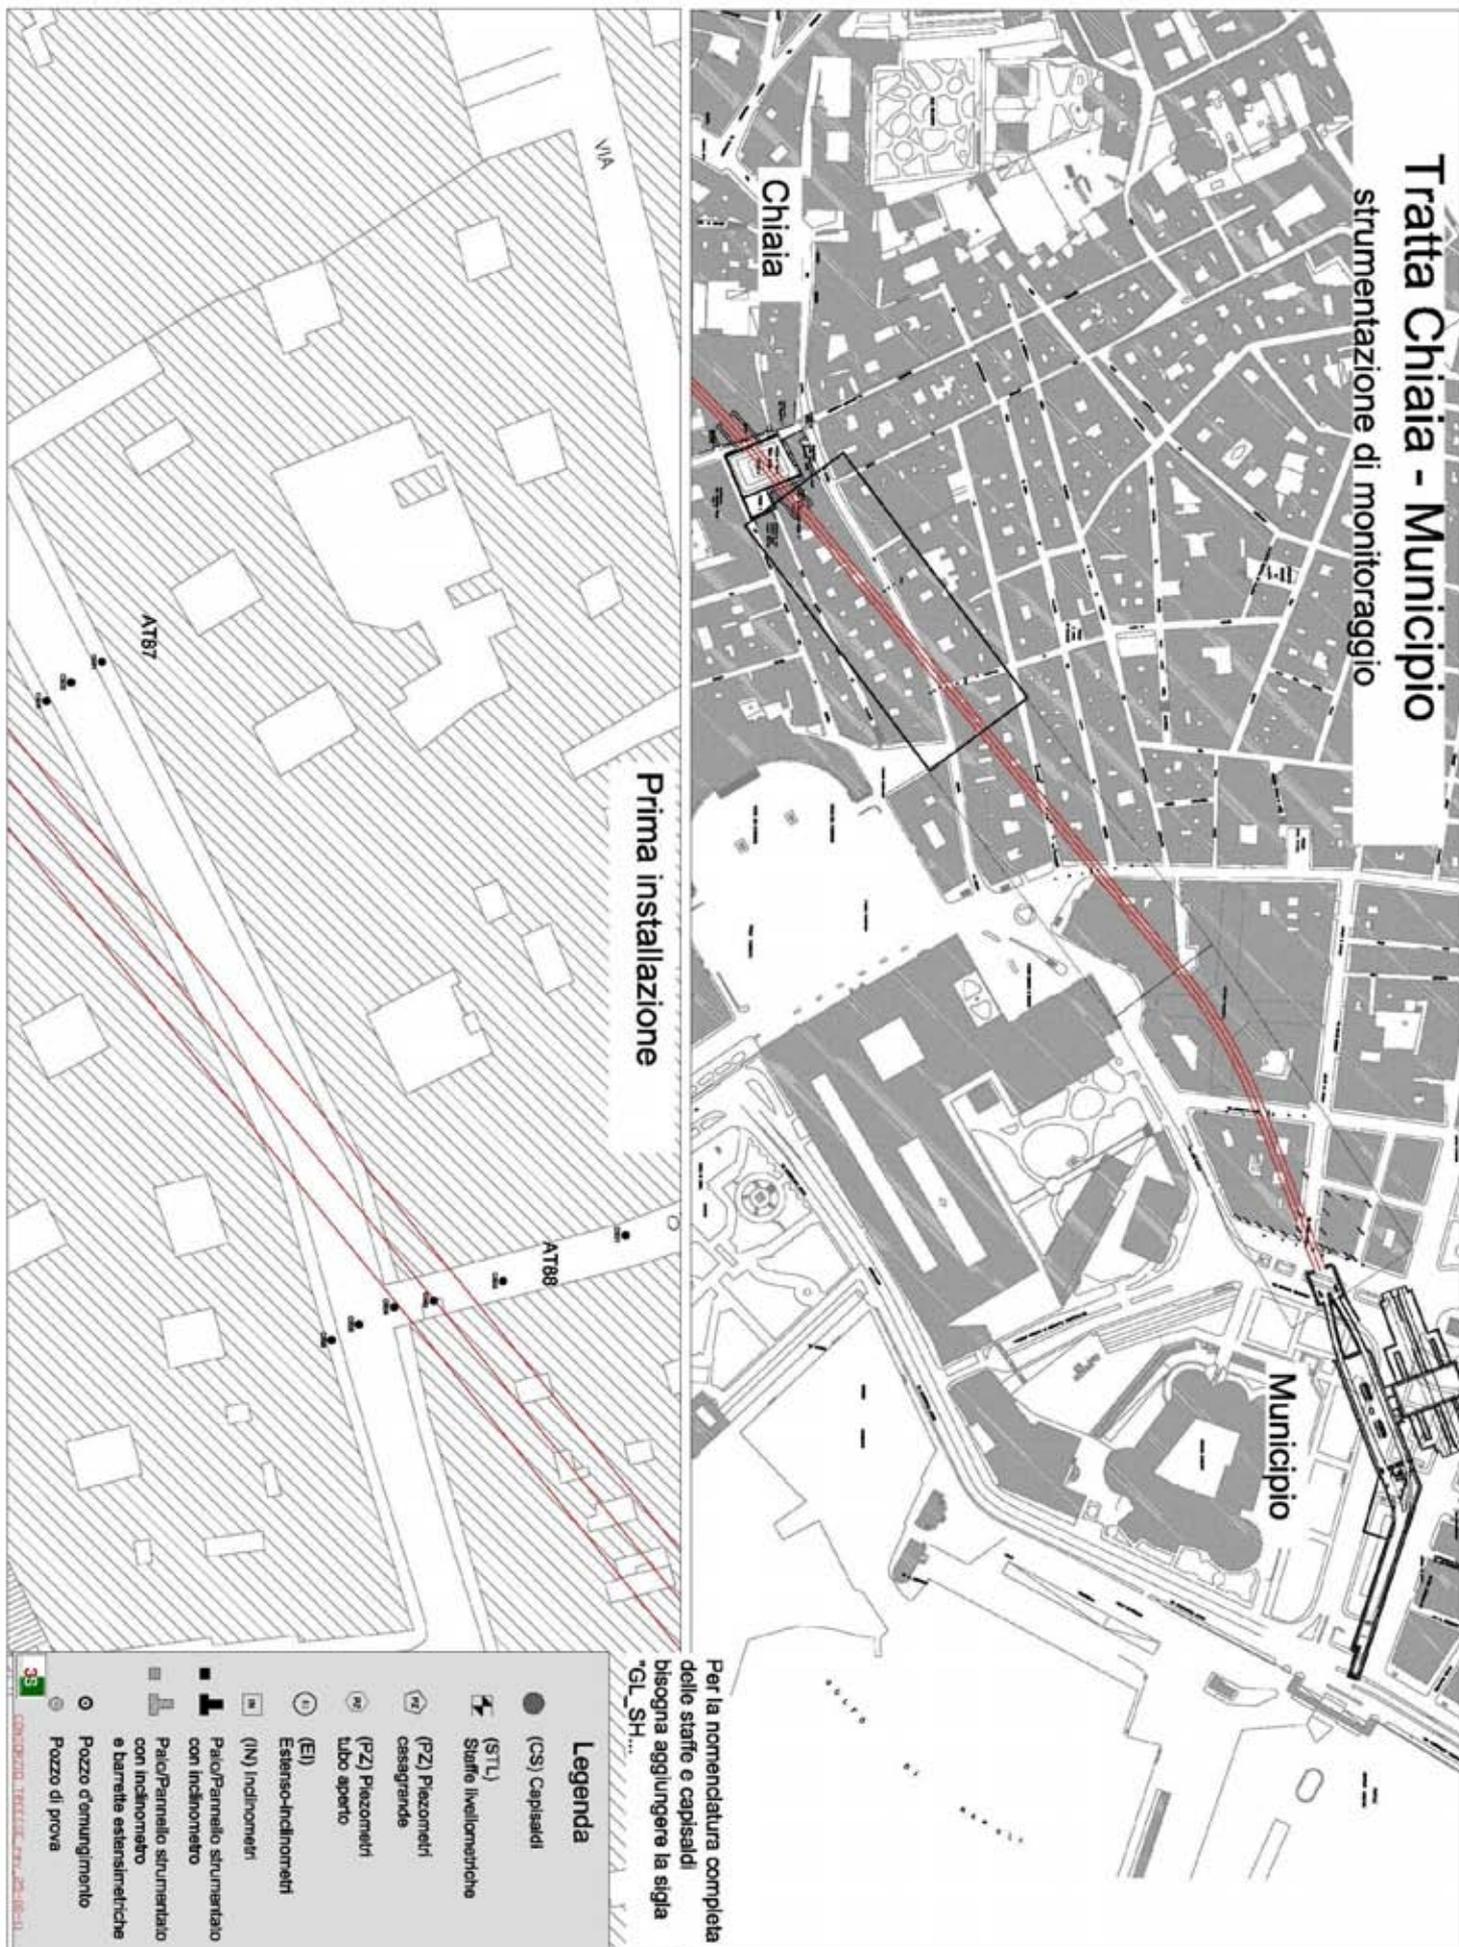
Planimetria tratta Chiaia - Municipio, raffigurante la disposizione della prima installazione della strumentazione di monitoraggio.
